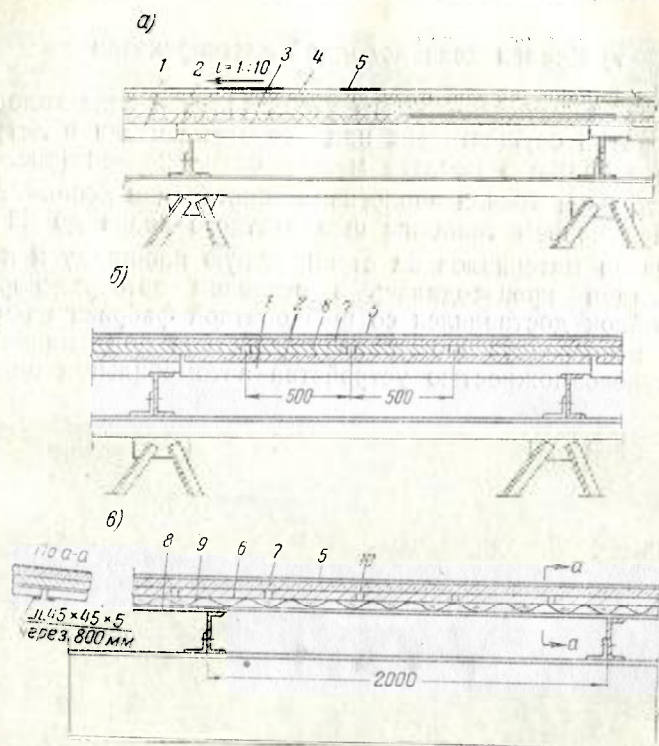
Конструкции утепленных кровель: а — типовая конструкция теплой кровли; б — выполненная в натуре кровля цеха прокатки тонкого листа (вариант ЮЖНИИ); в — выполненная в натуре кровля ремонтно-механического цеха треста «Запорожстрой»; 1 — железобетонные ребристые плитки; 2 — пароизоляция (огрунтовка битумом); 3 — засыпка гранулированным шлаком толщиной 80 — 120 мм; 4 — цементная стяжка 20 мм; 5 — руберид по пергамину на горячей клеемассе; 6 — шлаковойлок толщиной 22 — 33 мм (шашками из обрезков досок); 7 — армированная цементная стяжка, с сеткой 200 × 200 мм; 8 — асбестоцементные волнистые плиты; 9 — шлаковая корка толщиной 30 мм; 10 — прокладки из щебня
